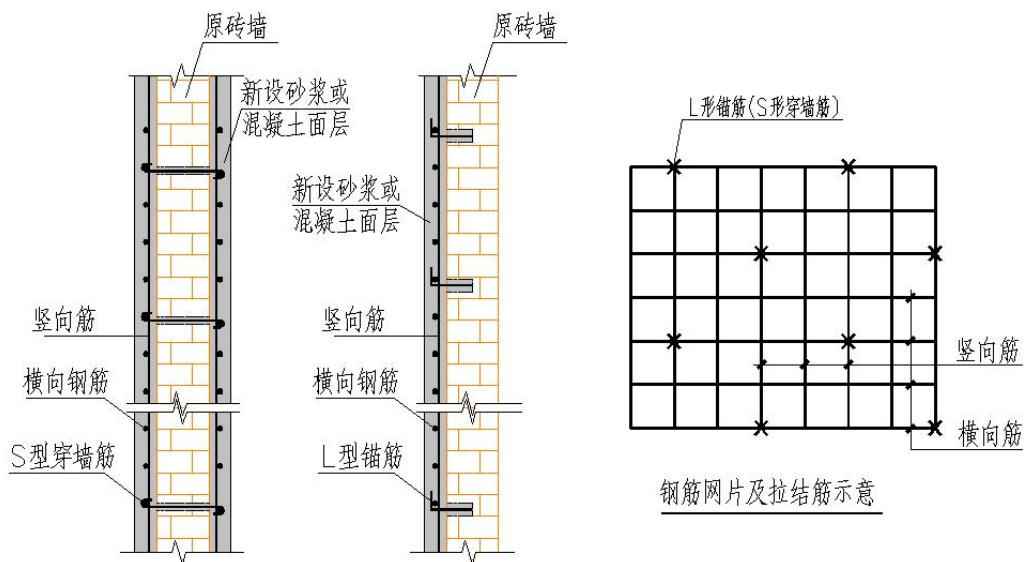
增设砂浆或混凝土板墙双面、单面加固墙体示意
